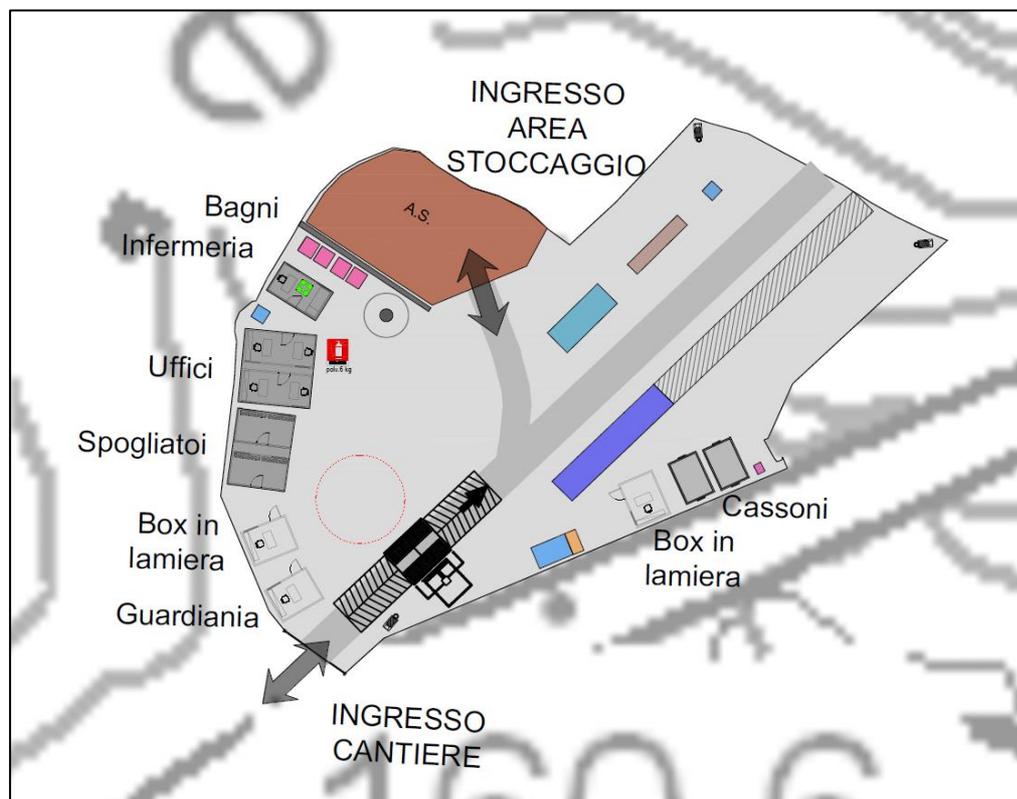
Layout cantiere operativo all'imbocco sud (CO 01)
